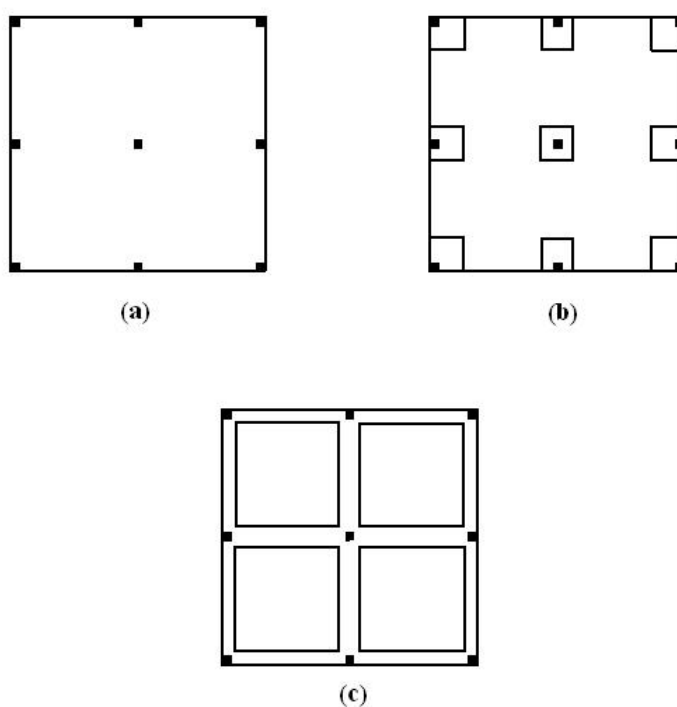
(a) Laje lisa; (b) Laje lisa com engrossamento dos pilares; (c) Laje com vigas faixa. (adaptado de Emerick, 2005)
